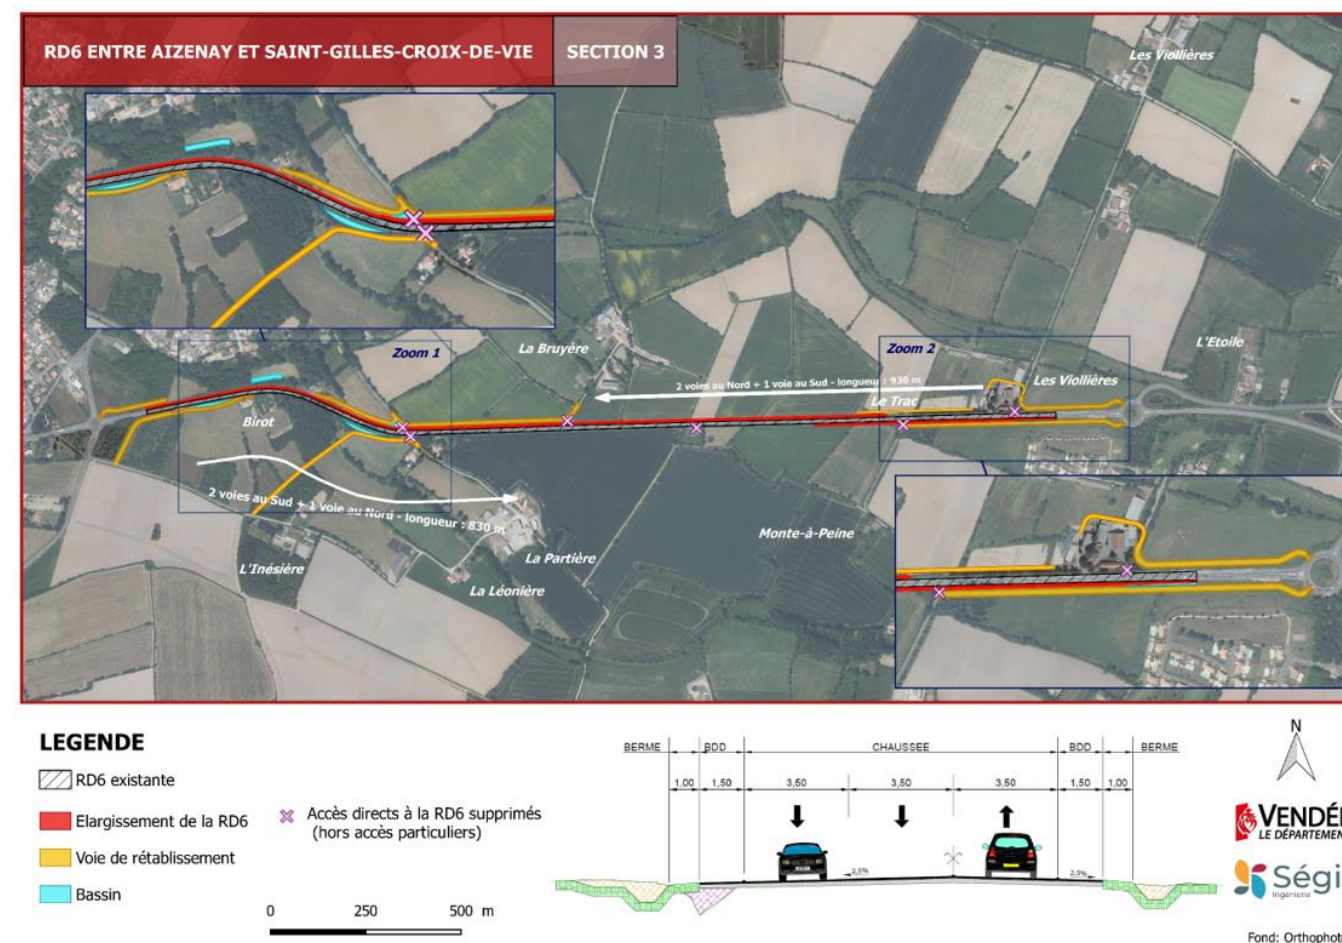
Plan de la section 3 retenue à l'issue de la concertation
